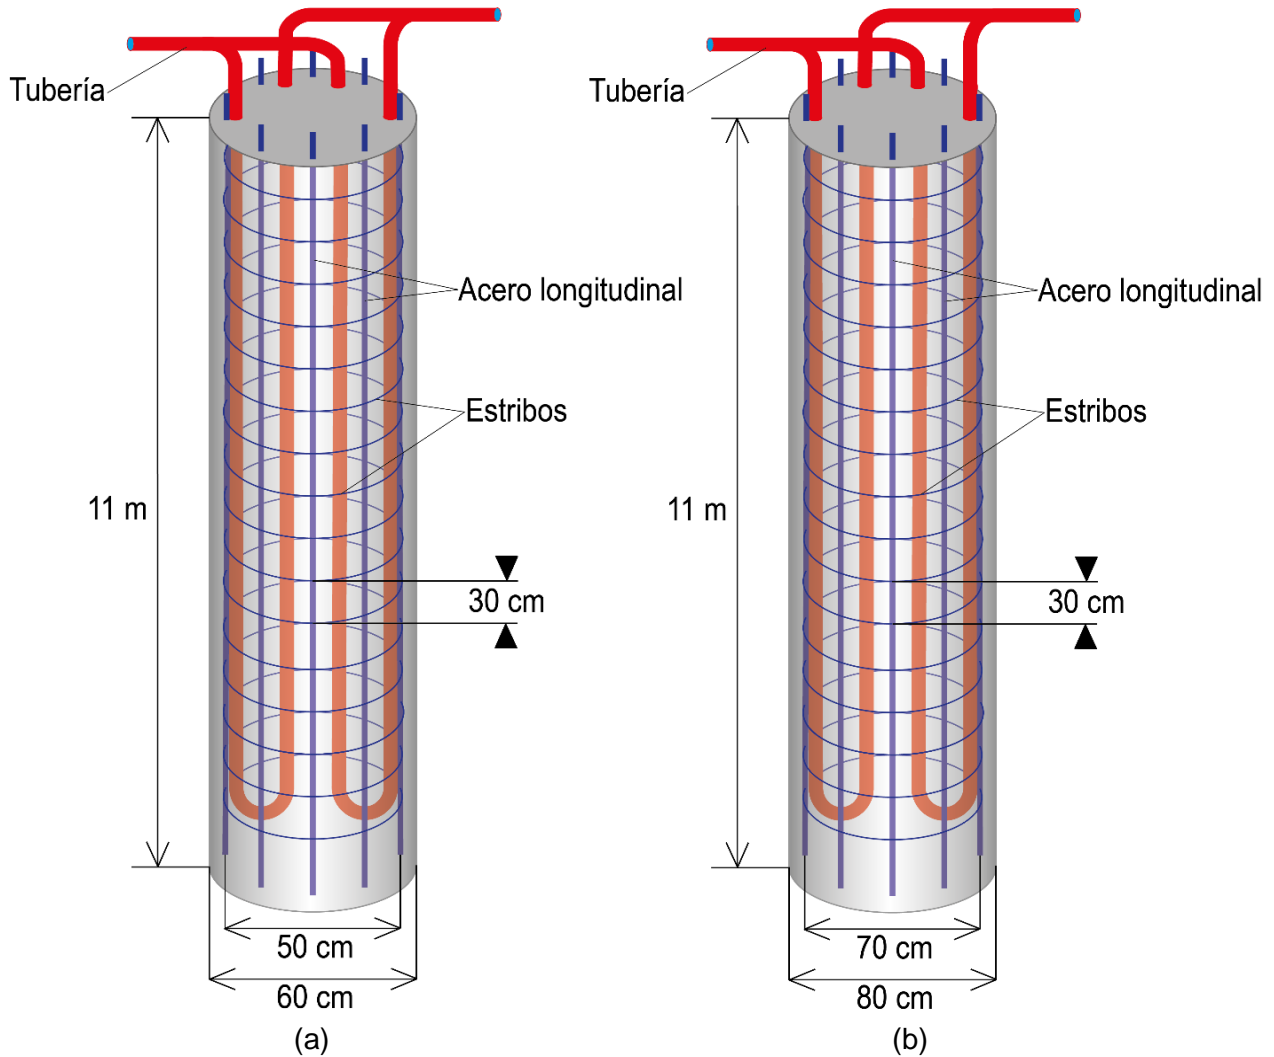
Esquema longitudinal de pila de energía con tubería de dos bucles en U (a) 60 cm de diámetro y (b) 80 cm de diámetro
